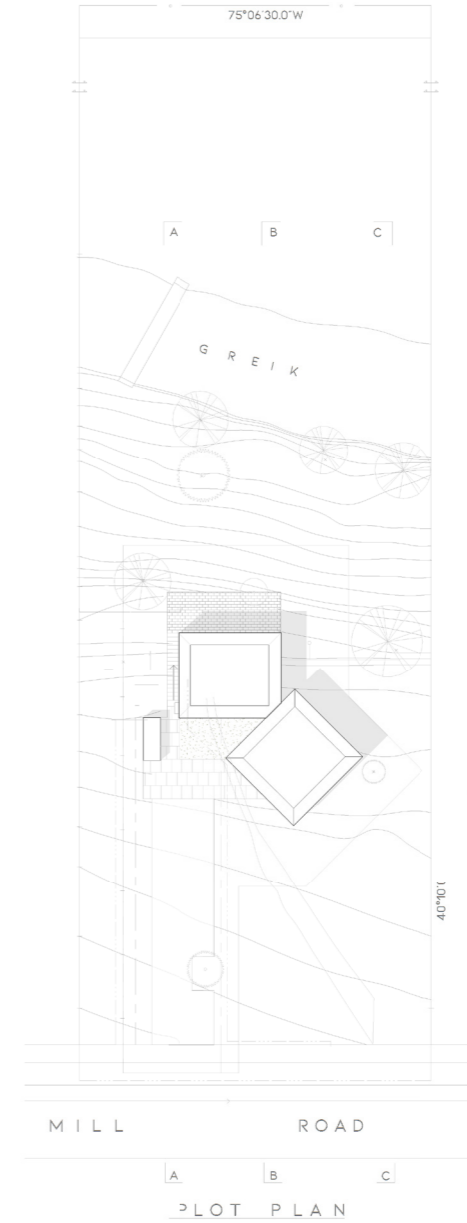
Vista planta emplazamiento modelada en Revit del proyecto Fisher House. Tratamiento de visualización : sombras y de línea oculta.
